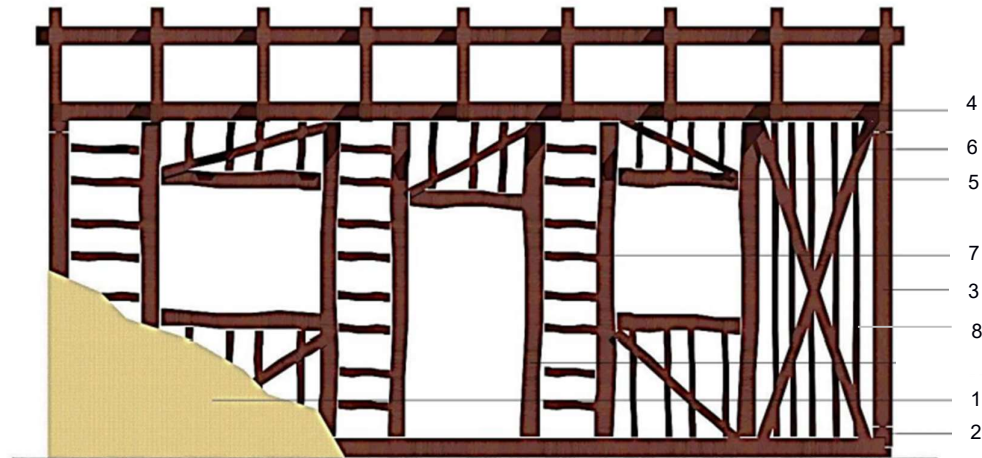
Sistema Constructivo de Madera y Bahareque [9]
